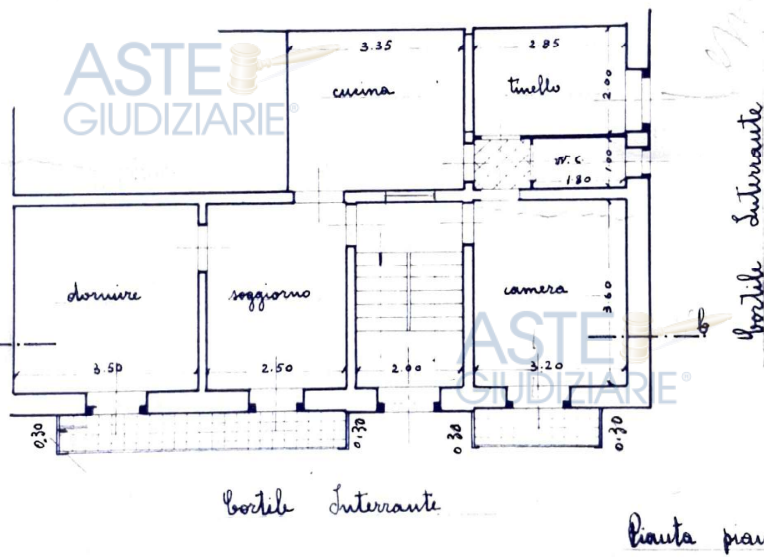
piano tipo progetto immobile via Alonge, prat. ed. n. 247/57
